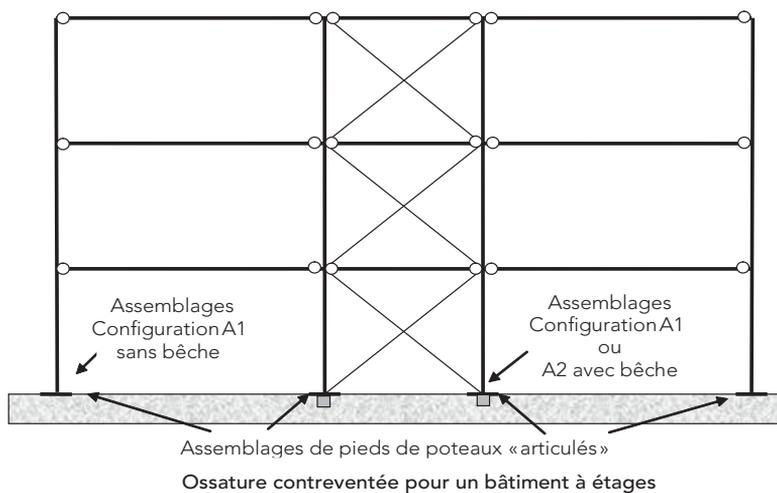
Assemblages « articulés » en pieds de poteaux d'un bâtiment à plusieurs niveaux.
